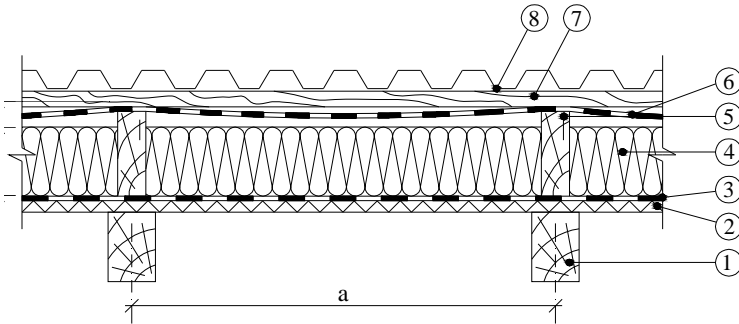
Схема «1». Вариант конструктивного решения устройства теплоизоляционного слоя и подкровельных пленок в конструкции покрытия. Утеплитель размещен над стропилами. Подшивка потолка располагается над стропильными ногами:
